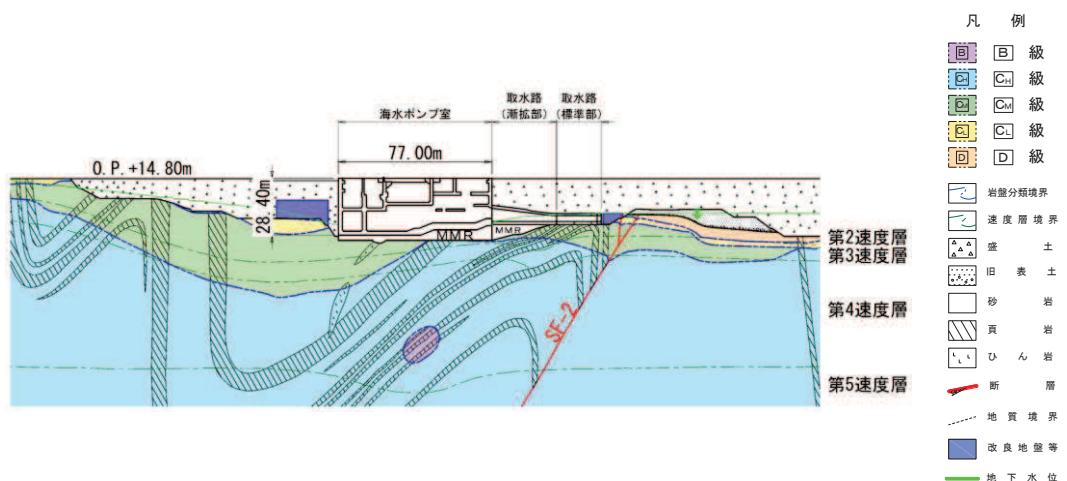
取水路（漸拡部）地質断面図（A-A 断面）
